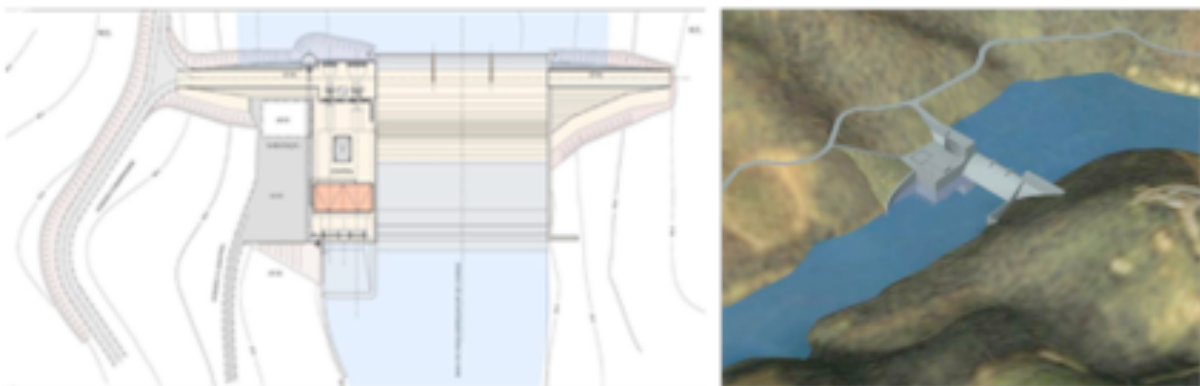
Planta e representação esquemática da barragem de Ermida (EDIA, 2010).
